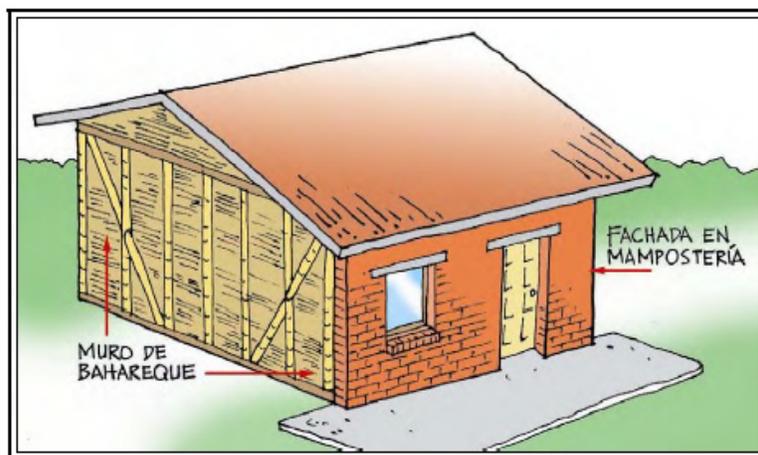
Combinación de sistemas constructivos. Fuente: AIS, 2002
